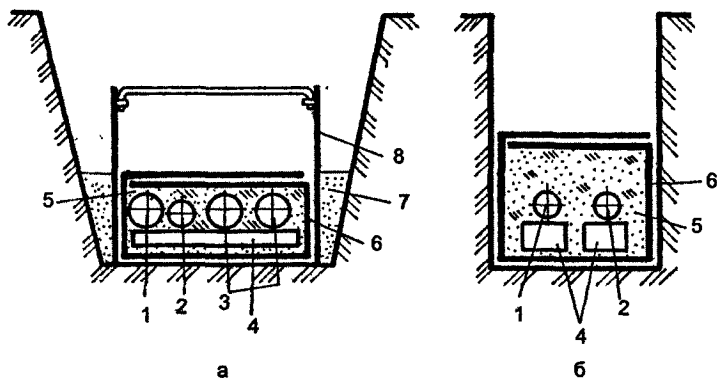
Схема уплотненных в траншею теплопроводов, изолированных ИГД:
